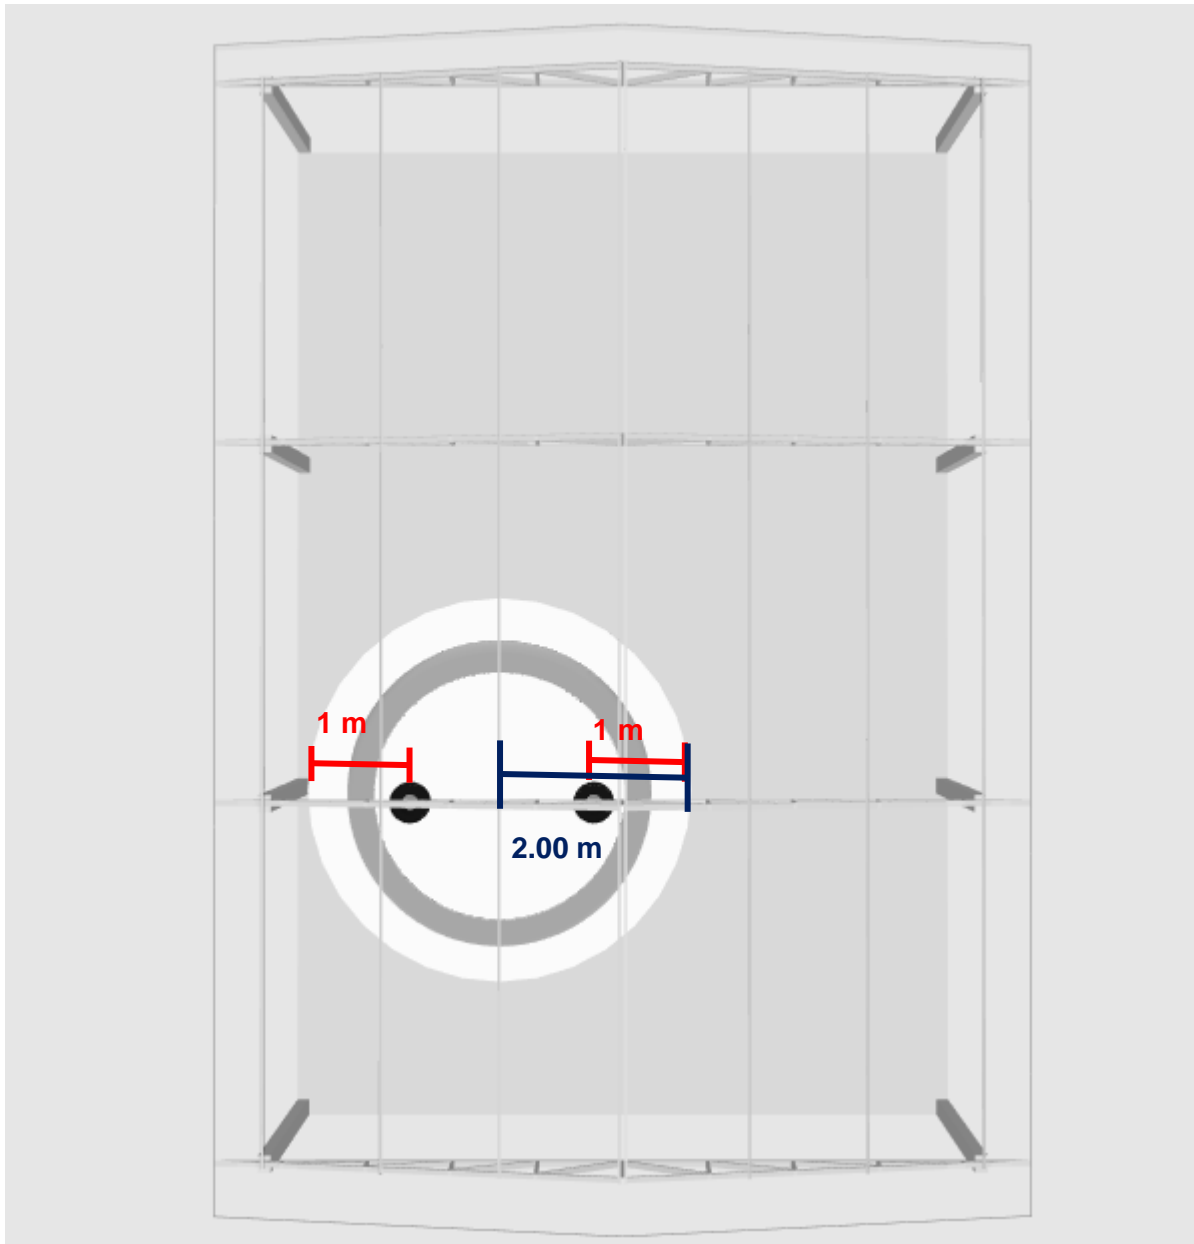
Propuesta de colocación del sistema de protección contra caídas. Vista superior.
